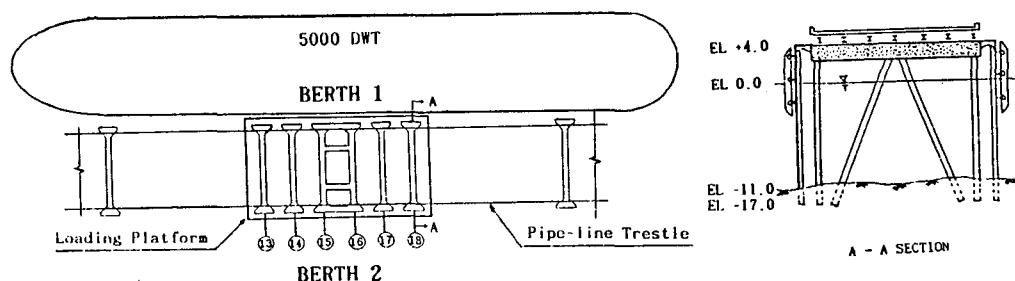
검토대상 잔교식 유류부두의 평면도 및 단면도
